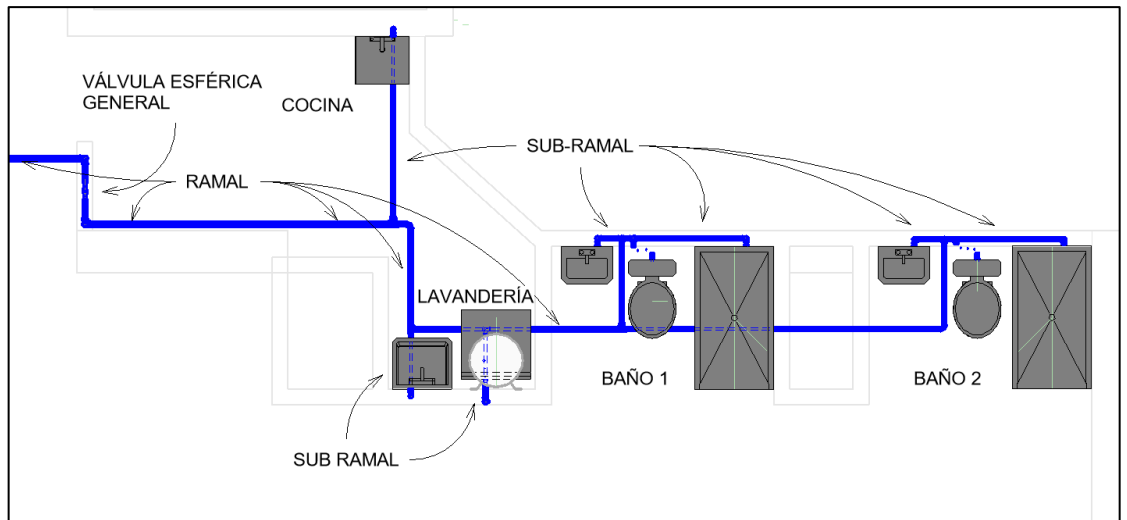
Vista en planta de distribución de agua fría en departamento.
